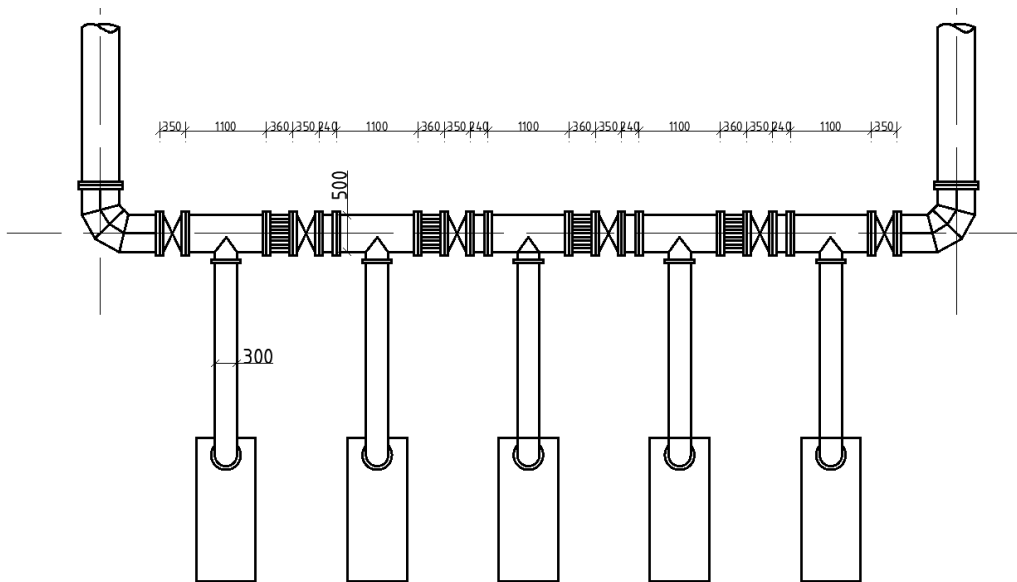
Схема розташування напірних трубопроводів всередині насосної станції
